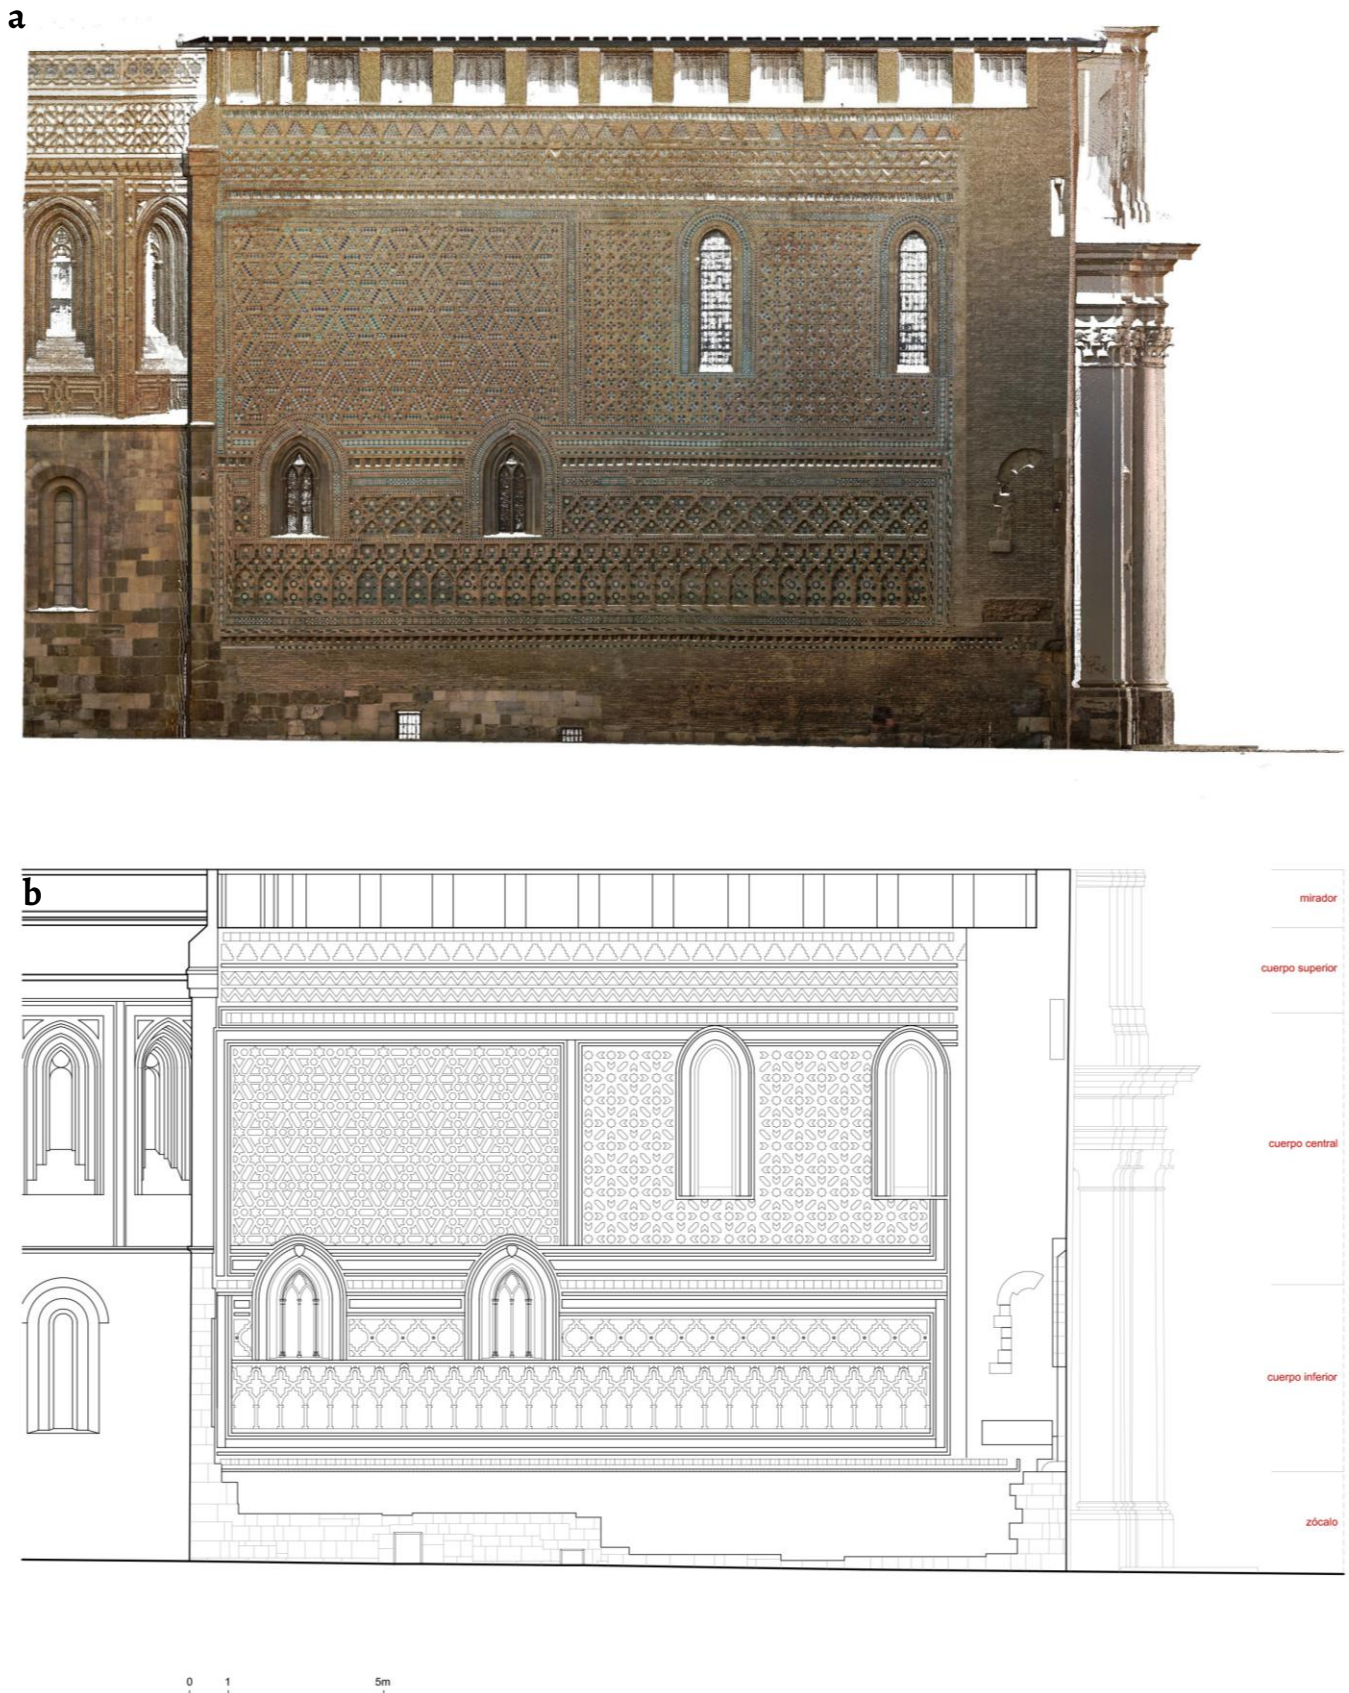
Estado actual de la fachada: a) ortofoto; b) delineado.
